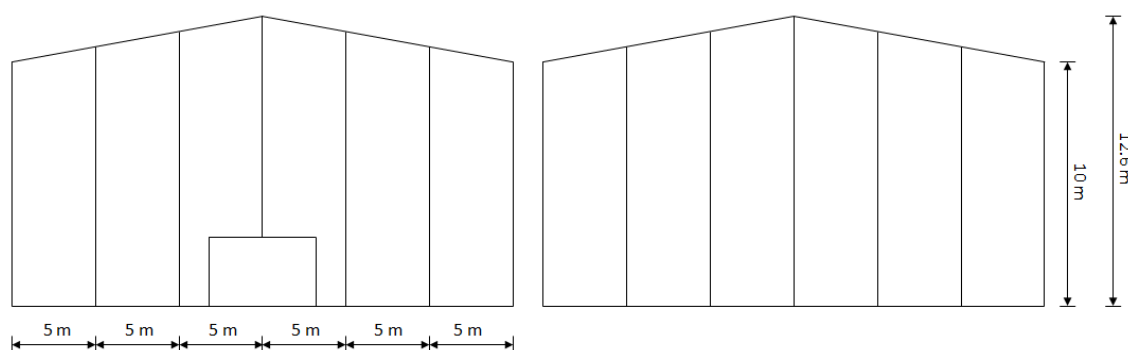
Posicionamento dos pilares nas fachadas de empena (com e sem portão)
